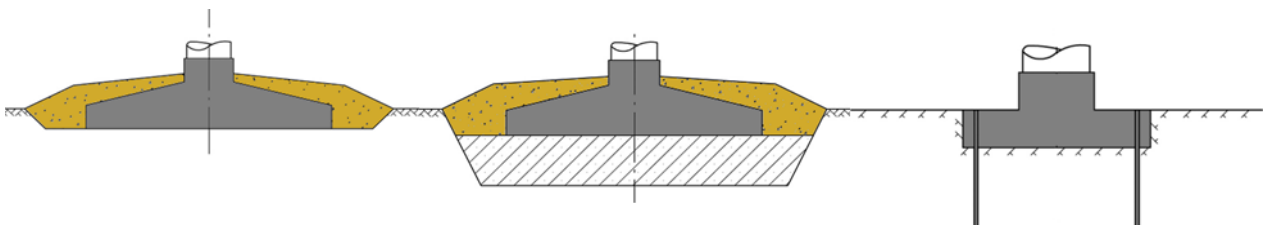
Principbilder på en grund av armerad betong på mark (till vänster), en grund av armerad betong med massa-byte (i mitten) samt bergsförankrad grund av armerad betong (till höger).
